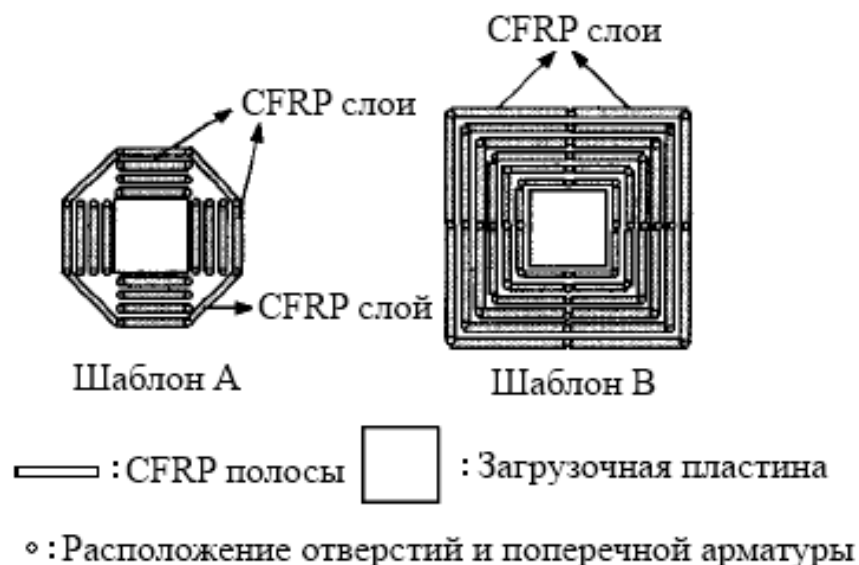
Схемы армирования плиты вокруг колонны (вид в плане) [8]
